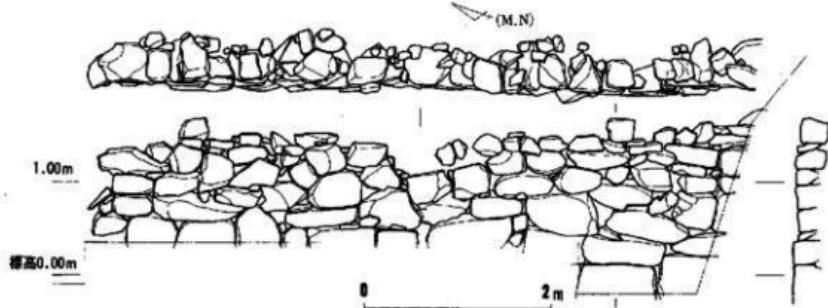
赤坂門城壁平面・立面及び断面図 (1/60)
